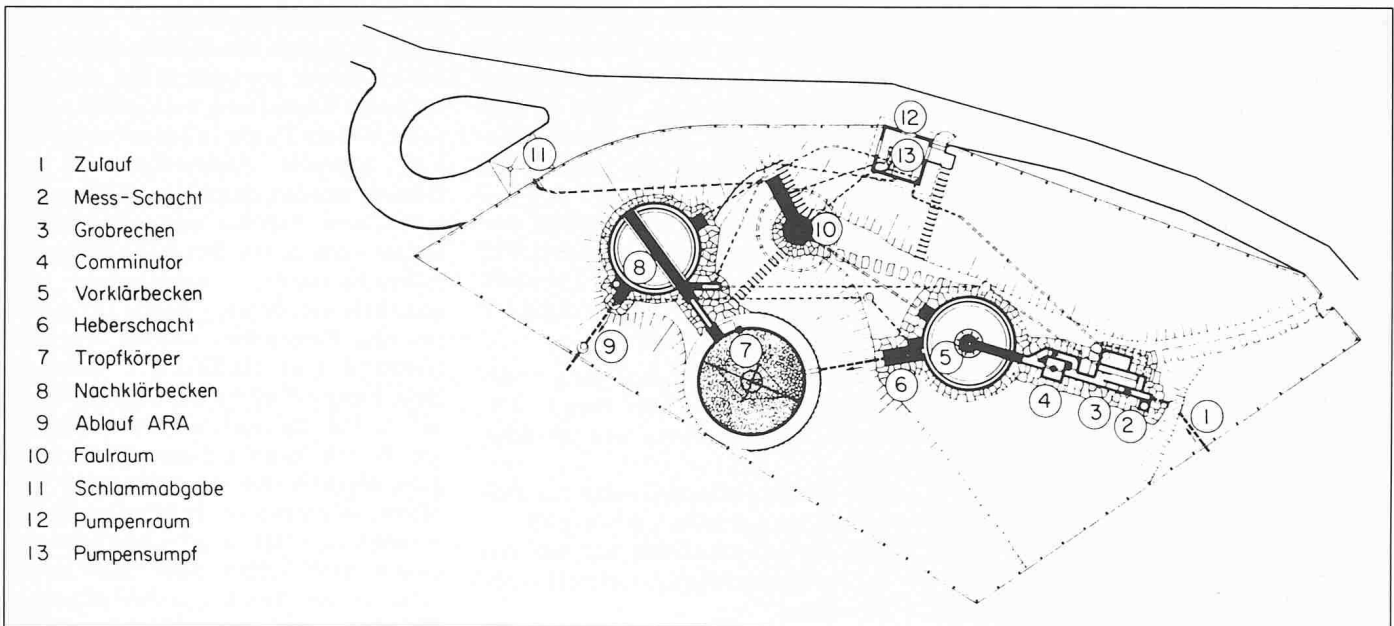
Lageplan der Abwasserreinigungsanlage Monte Ceneri
